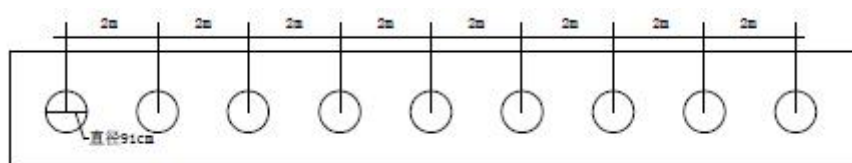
单位帷幕灌浆轴线展开平面示意图
